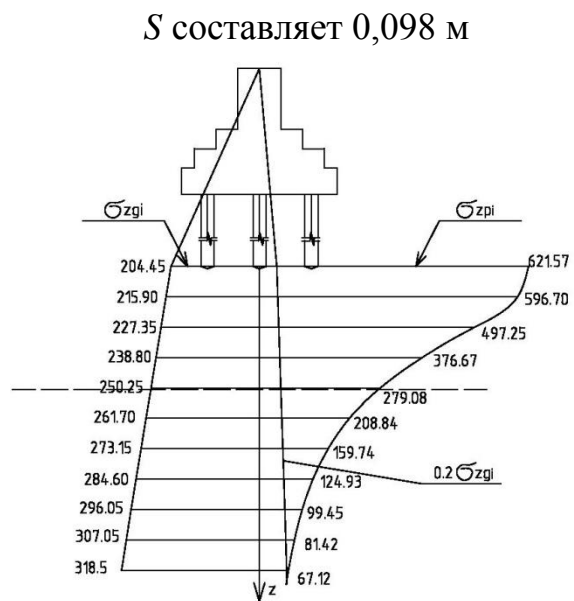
Расчет осадки фундамента методом буронабивных свай
